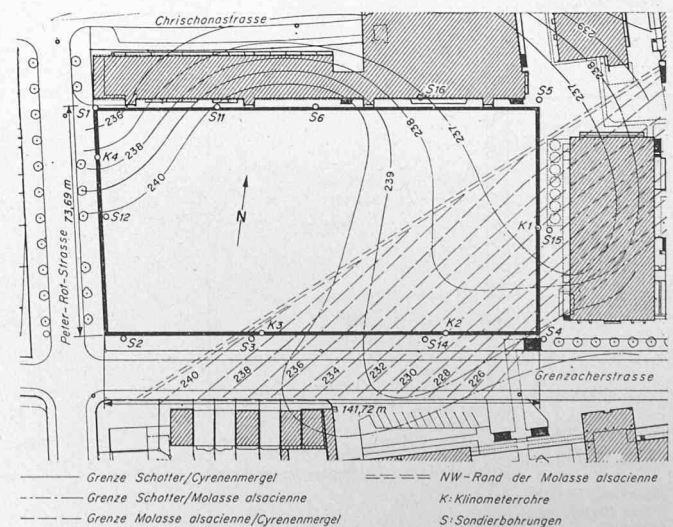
Grundriss der Baugrube mit Höhenschichtlinien der Süsswassermolasse, unterteilt in Cyrenenmergel und Molasse alsacienne. Lage der Sondierbohrungen S1 bis S15 und der Klinometerrohre K1 bis K4
